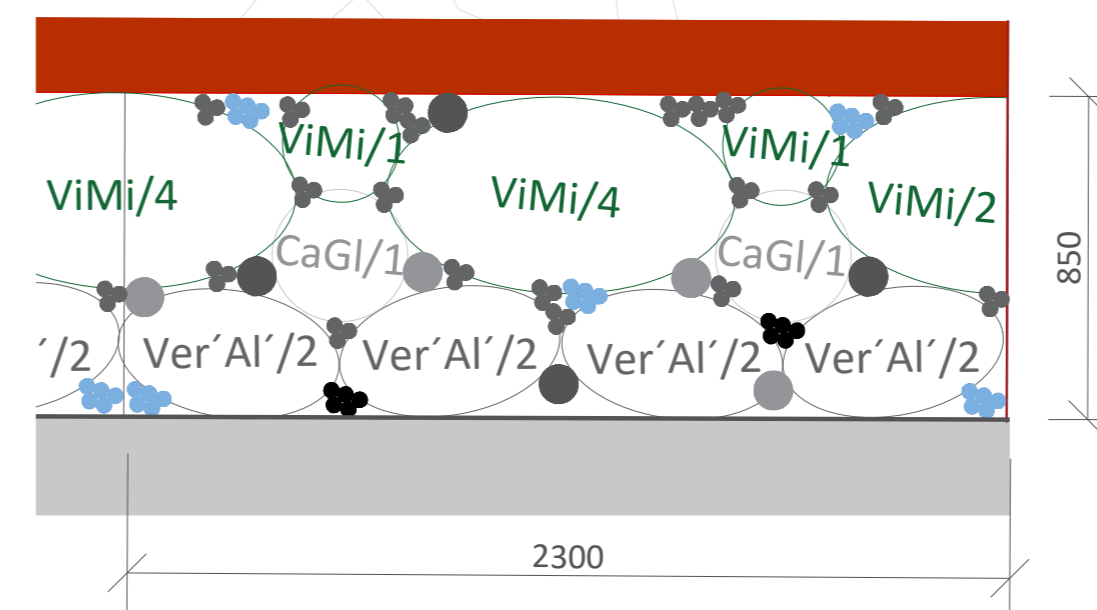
# DETAIL (PZ) - modul P2 M1:20 varianta STÍN
